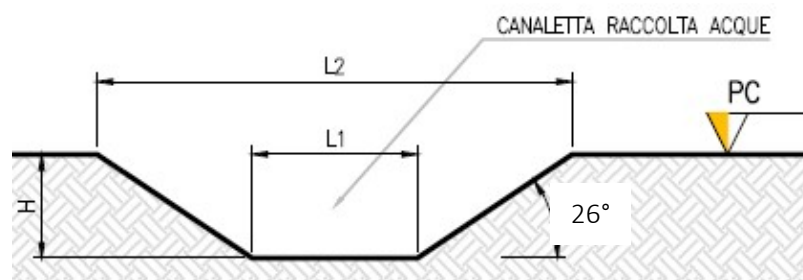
Sezione tipologica canaletta di drenaggio realizzata in scavo.
